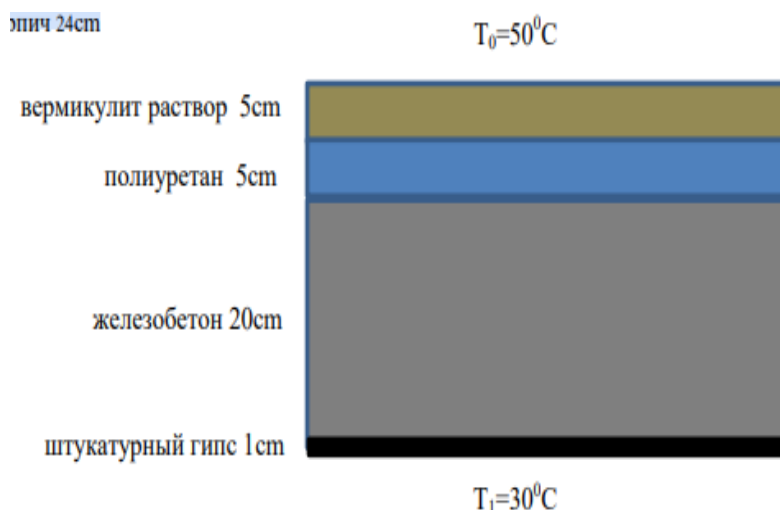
Схема бетонной потолок стены с теплоизоляционными слоями
